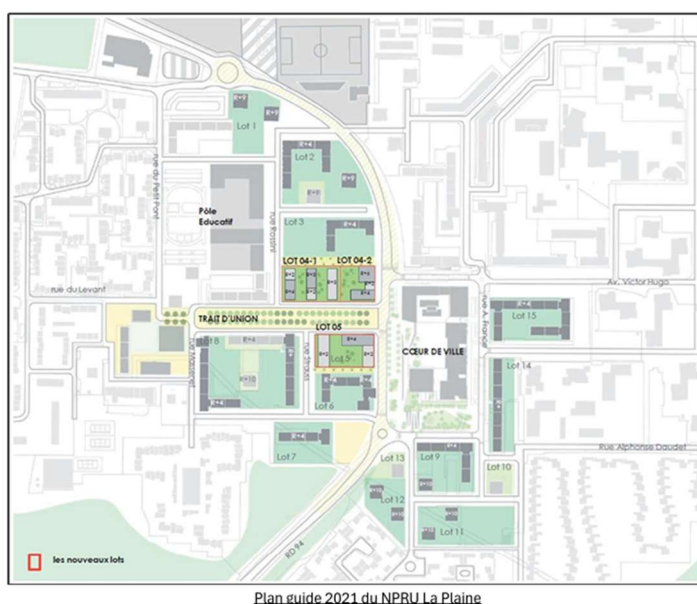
Plan de masse du "Trait d'union" (Source : Ville-epinay-senart.fr)
